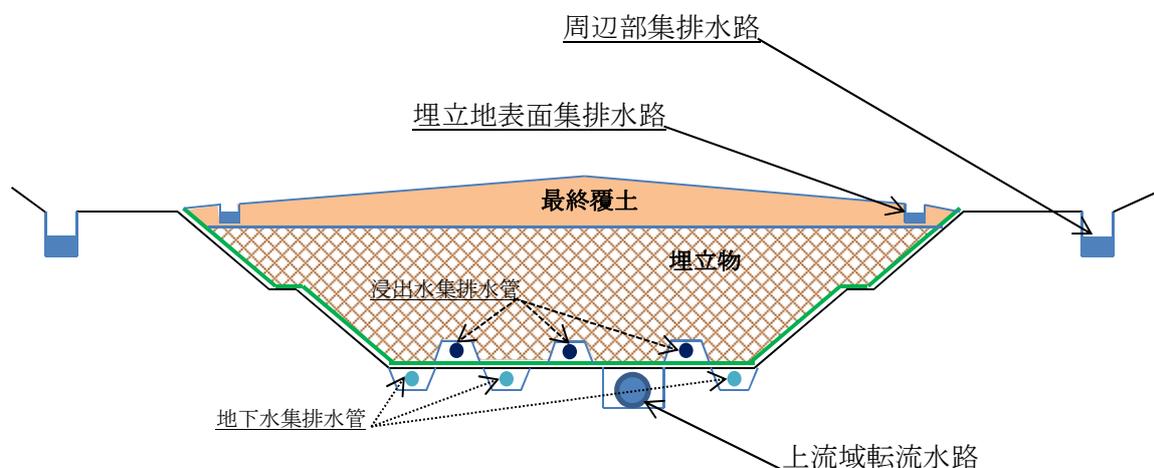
雨水集排水路配置概略断面図例 (埋立完了後)
